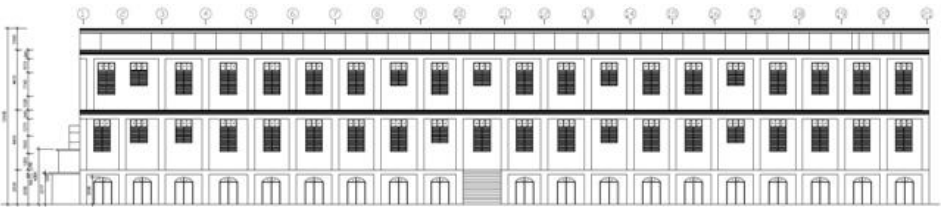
Vista posterior del edificio. Fuente: Proyecto técnico OCC, 2018.
